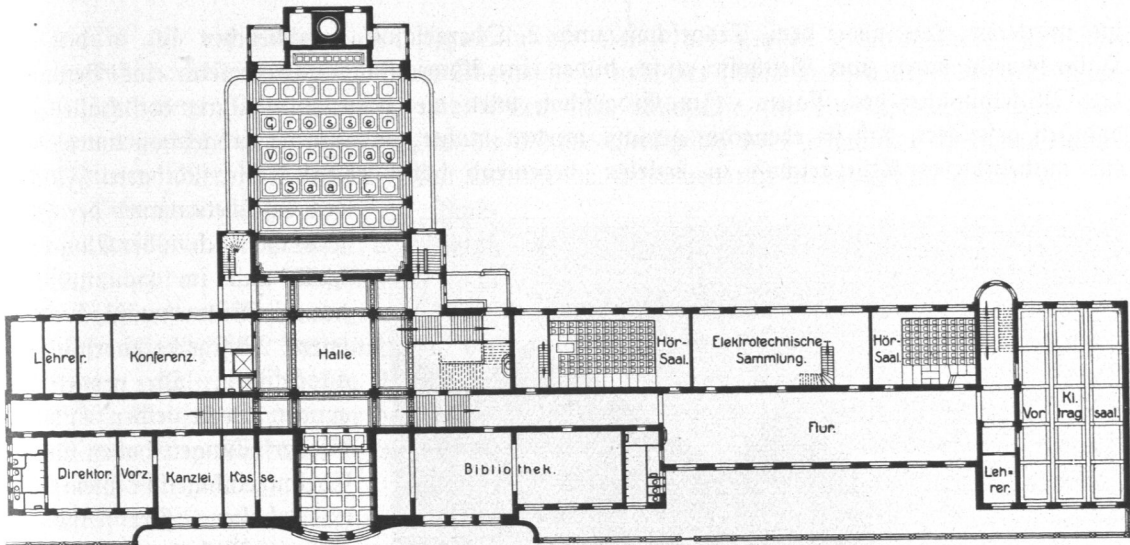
Hauptgebäude der Technischen Staatslehranstalten, Grundriß, Erdgesch.ß.
